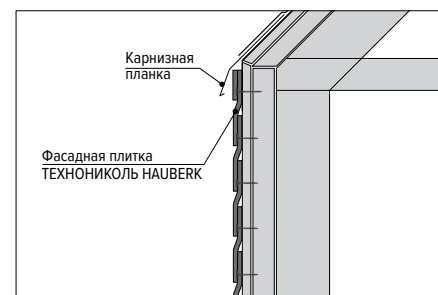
Монтаж верхнего ряда в домах без карнизного свеса
